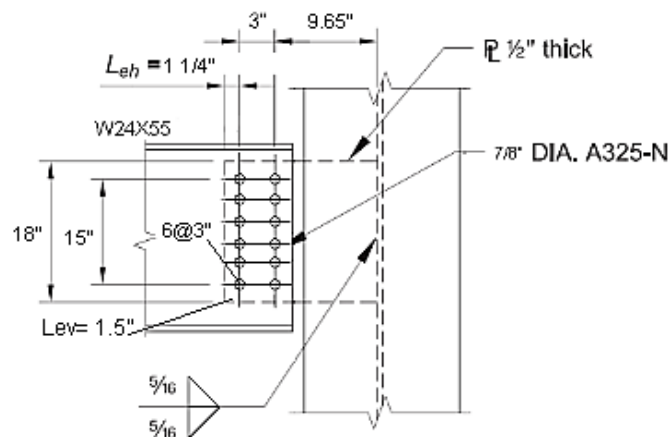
Conexión viga - alma de columna. Fuente: Propia realizado en AUTOCAD.
